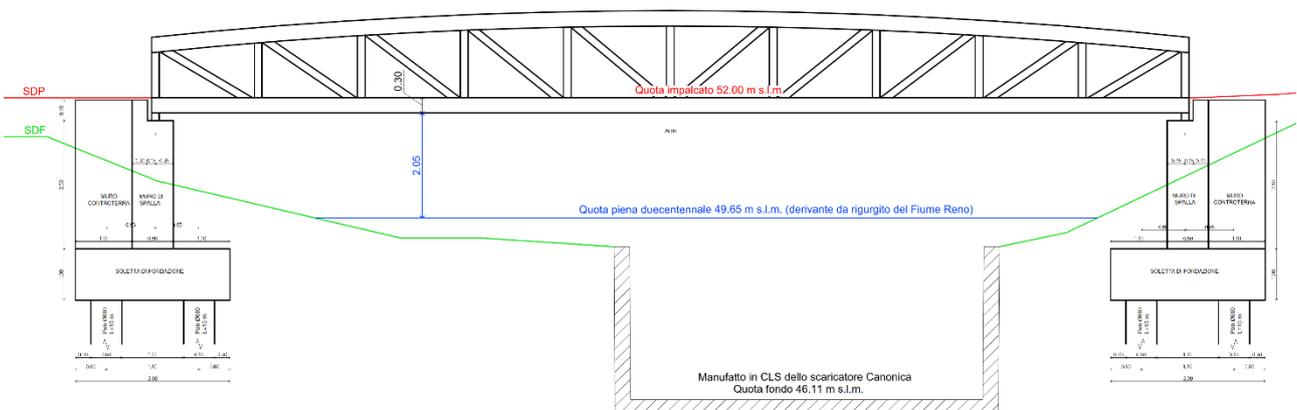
Sezione longitudinale impalcato e spalle
